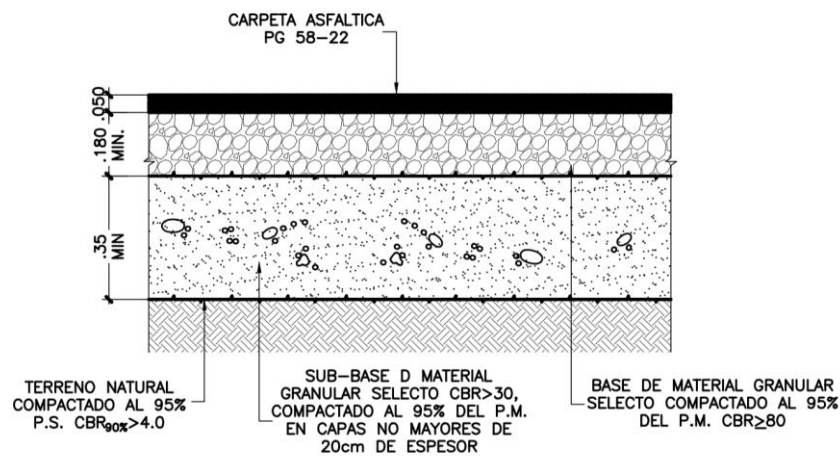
Estructura de pavimento flexible suministrada por HEMECA Arquitectura S.A.
